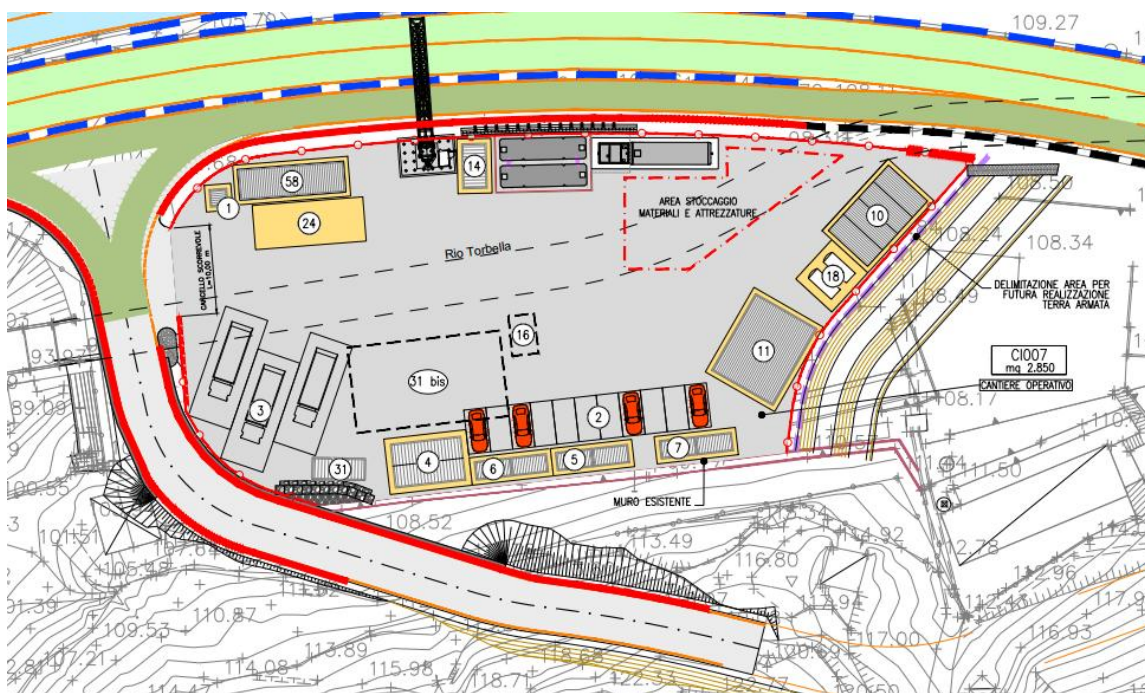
Layout del campo CI007 – apprestamenti di cantiere di prima fase
